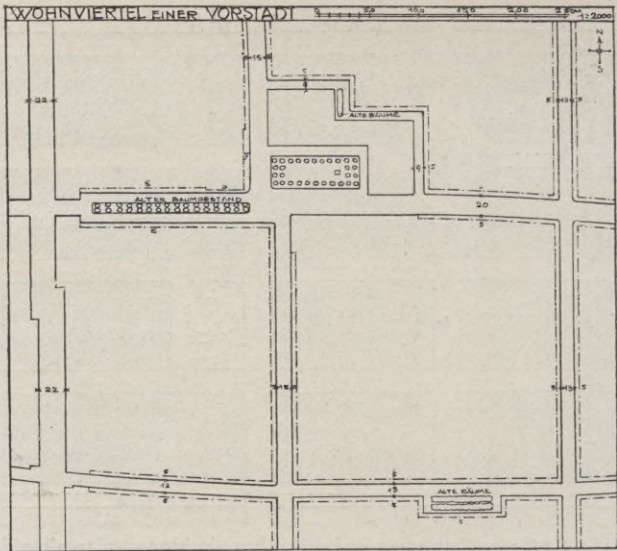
Ausschnitt aus einem gesetzlichen Bebauungsplan. (Bestimmung: höchstens ein Drittel Bebauung und 2 Obergeschosse).
